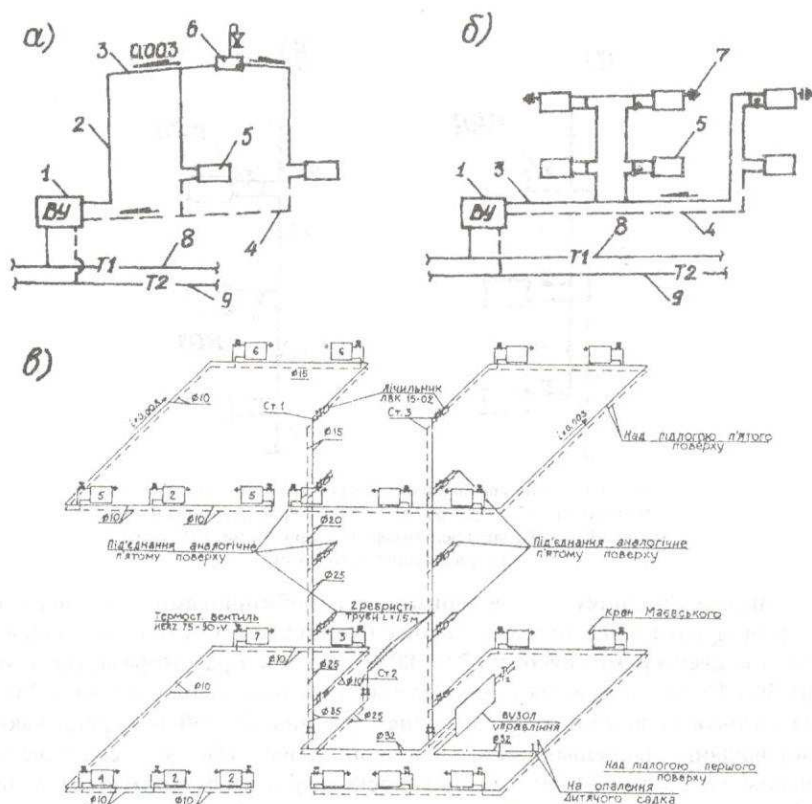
Схеми систем опалення, поєднаних з тепломережею, з подавальним верхнім розвідним трубопроводом (а) і з подавальним нижнім розвідним трубопроводом (б, в):
